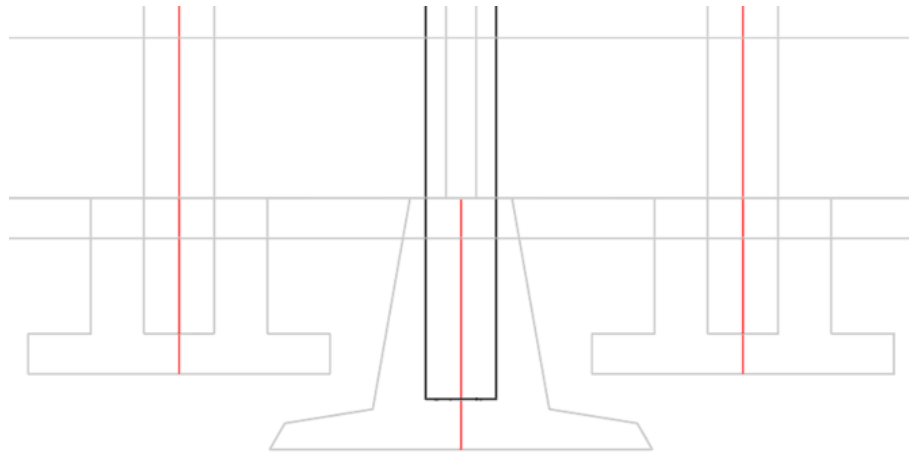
Placas aisladas del límite entre la nave industrial y la bodega semiabierta
